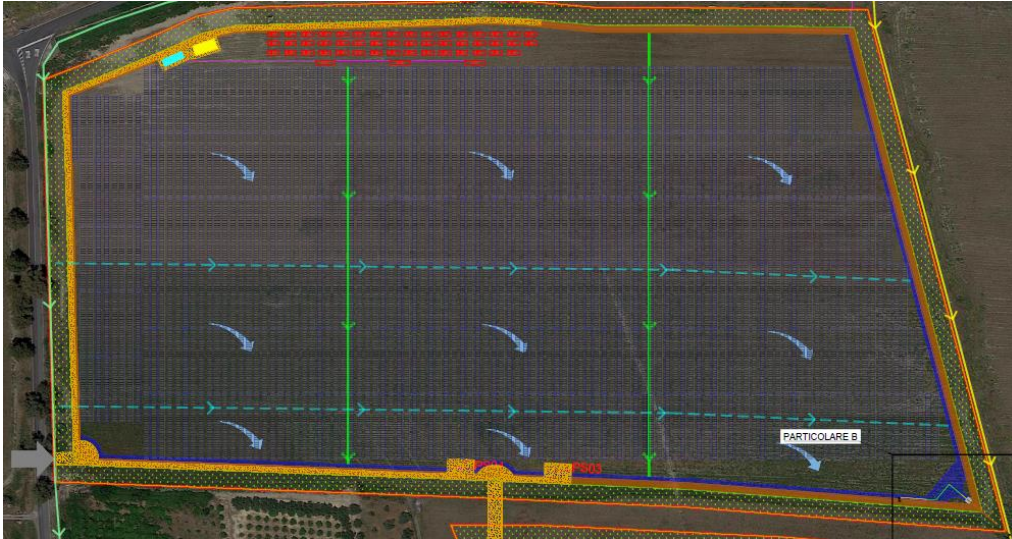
Sistema di drenaggio acque meteoriche – Planimetri Area Ovest – Stralcio tavola progettuale
